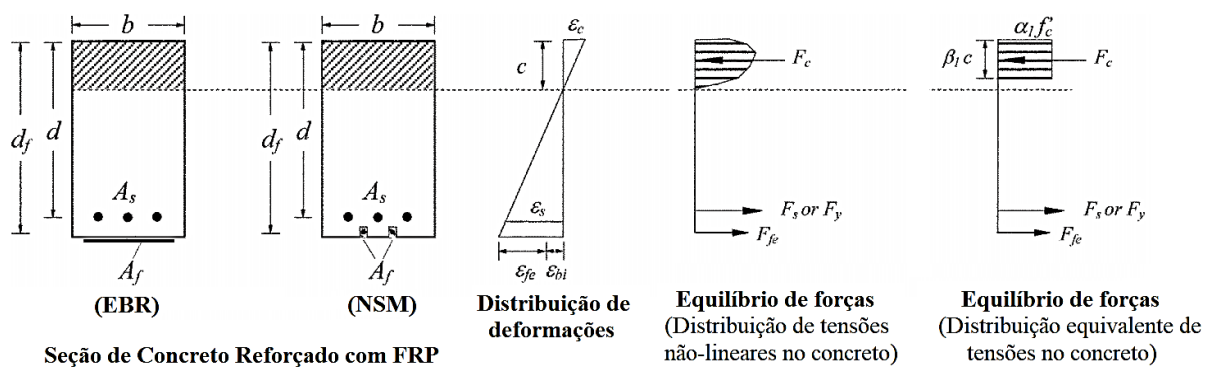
Equilíbrio de uma seção em concreto armado reforçada a flexão com FRP, Adaptado do ACI 440.2R (2017).
